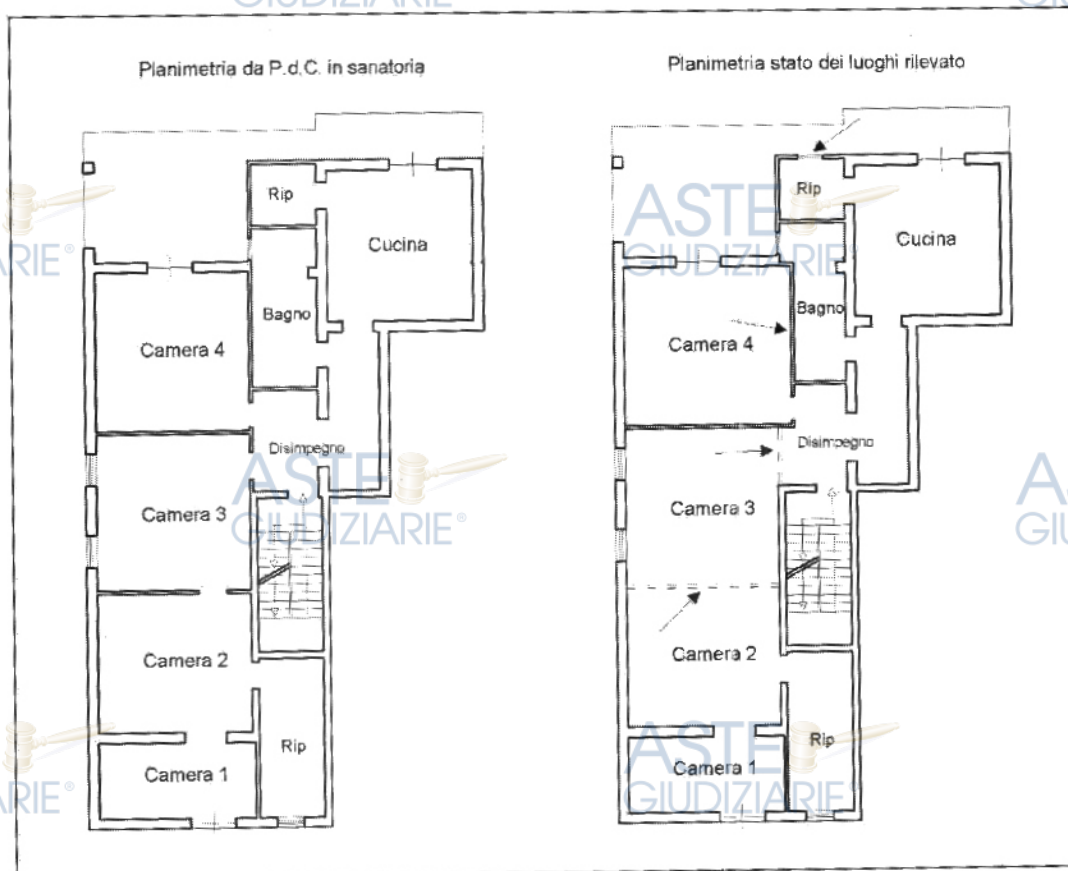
A sx planimetria stato da concessione a dx planimetria stato di fatto - le frecce indicano le difformità riscontrate
